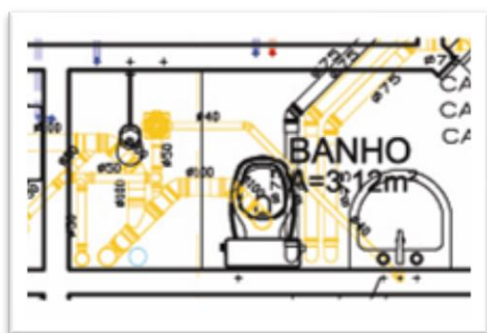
Planta baixa do desalinhamento prumadas de esgoto e pluvial com parede.
